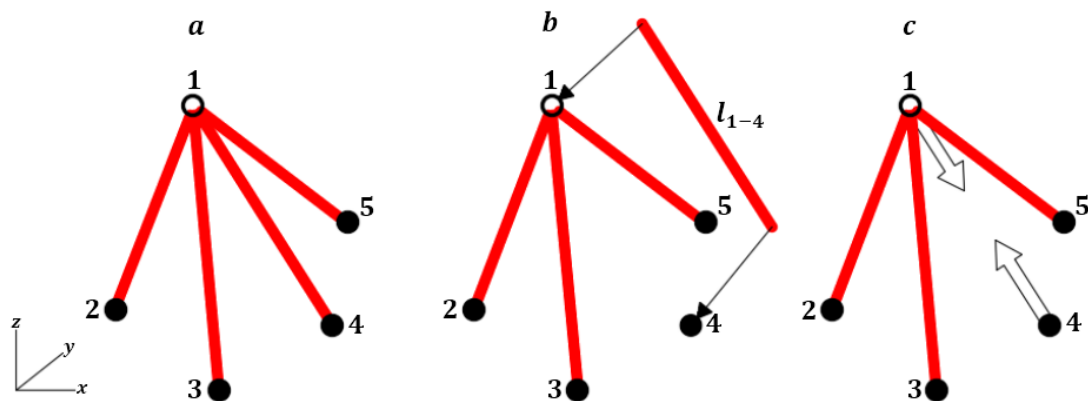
Estructura reticular. a) Sistema estáticamente indeterminado b) y c) Estado inicial de esfuerzo, adaptado de (Motro, 2006).
